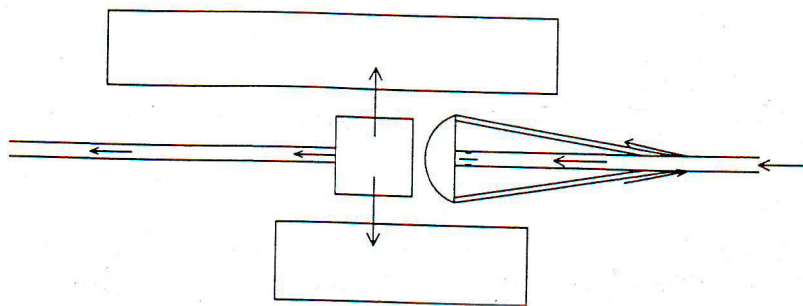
Le plan masse (forme par l'architecture ajoutée)
